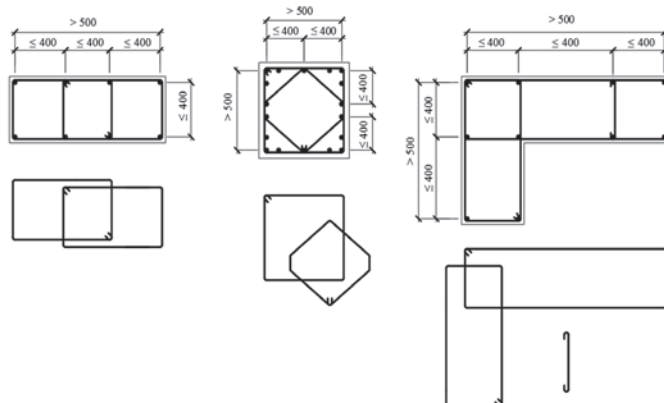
Примеры охвата поперечной вязаной арматурой нескольких продольных стержней в различных формах поперечных сечений монолитных колонн
